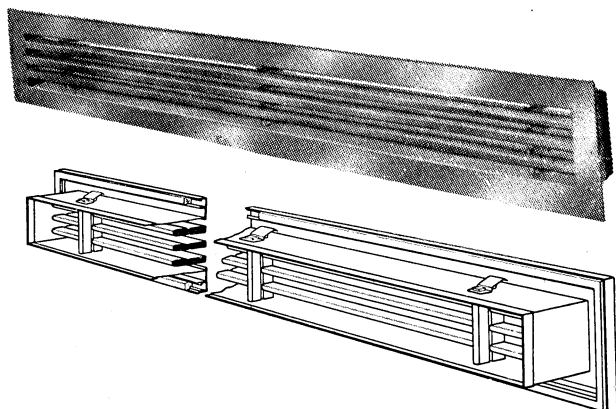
Vyústka s pevnými lisovanými listy (Dry Manufacturing Co., USA).
